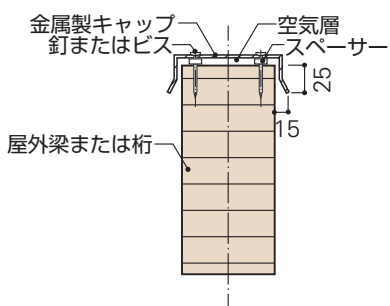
保護材の板金と木材の間に隙間を設ける例(American Institute of Timber Construction, AITC Technical Note 108-84, 1984より作図)
